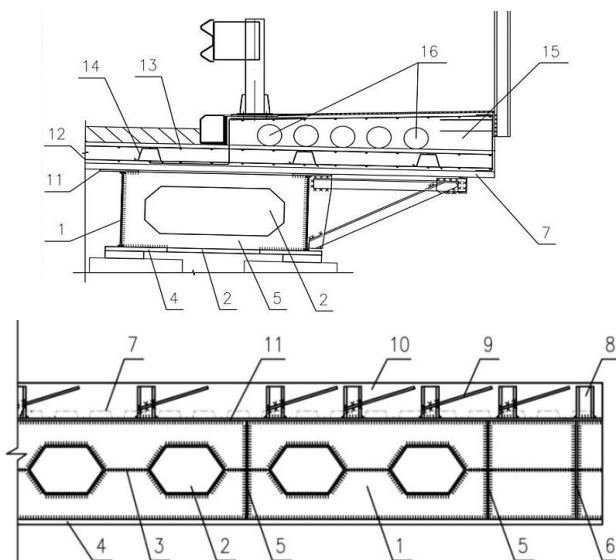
Конструкция блока пролетного строения моста: 1 – главные балки; 2 – шестиугольные отверстия; 3 – сварной шов; 4 – нижний пояс; 5 – промежуточные диафрагмы; 6 – опорные диафрагмы; 7 – профилированный лист; 8 – жесткий элемент связи сдвига; 9 – гибкий элемент связи сдвига; 10 – железобетонная плита проезжей части; 11 – верхний пояс; 12, 13 – нижняя и верхняя арматурные сетки плиты проезжей части; 14 – хомутов; 15 – тротуарный блок; 16 – неизвлекаемые вкладыши пустотообразователи
